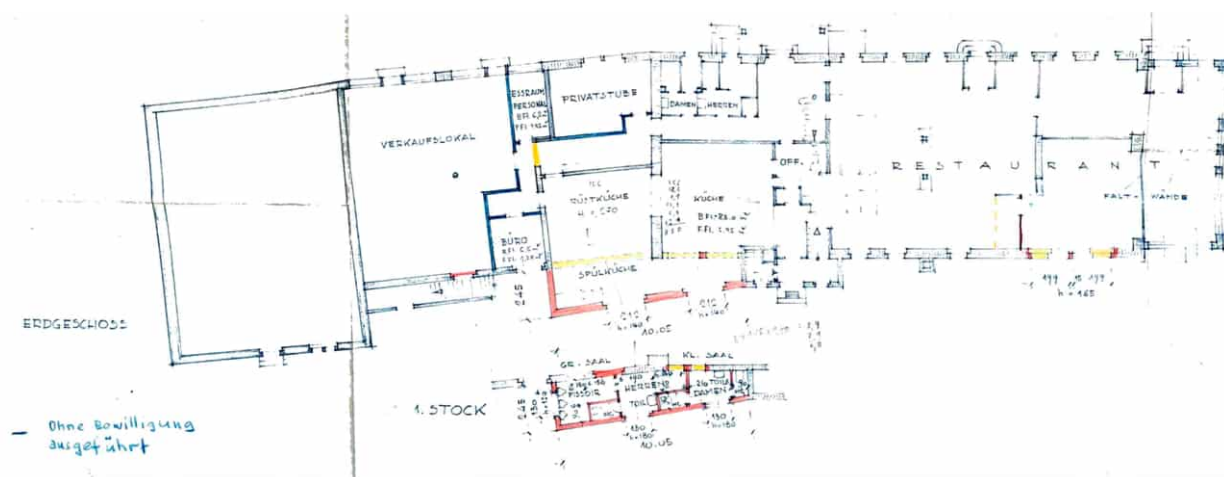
Umbauplan 1961 (nicht umgesetzt): Küchenerweiterung (mehrgeschossig) und Umbauten am Restaurant.
